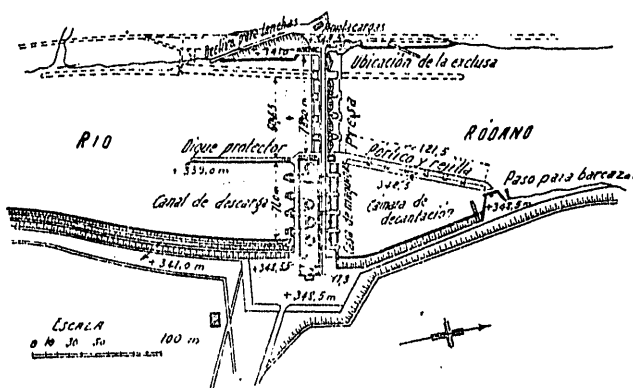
ª Presa y casa de máquinas de Chancy-Pougny
